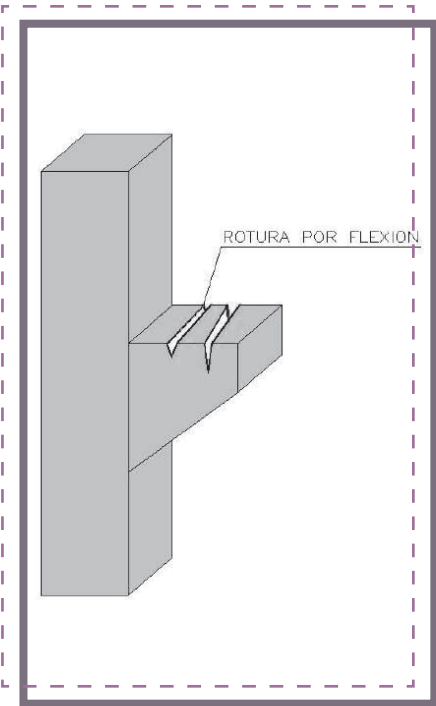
Imagen de las fisuras en ménsula de hormigón armado por rotura a flexión.
